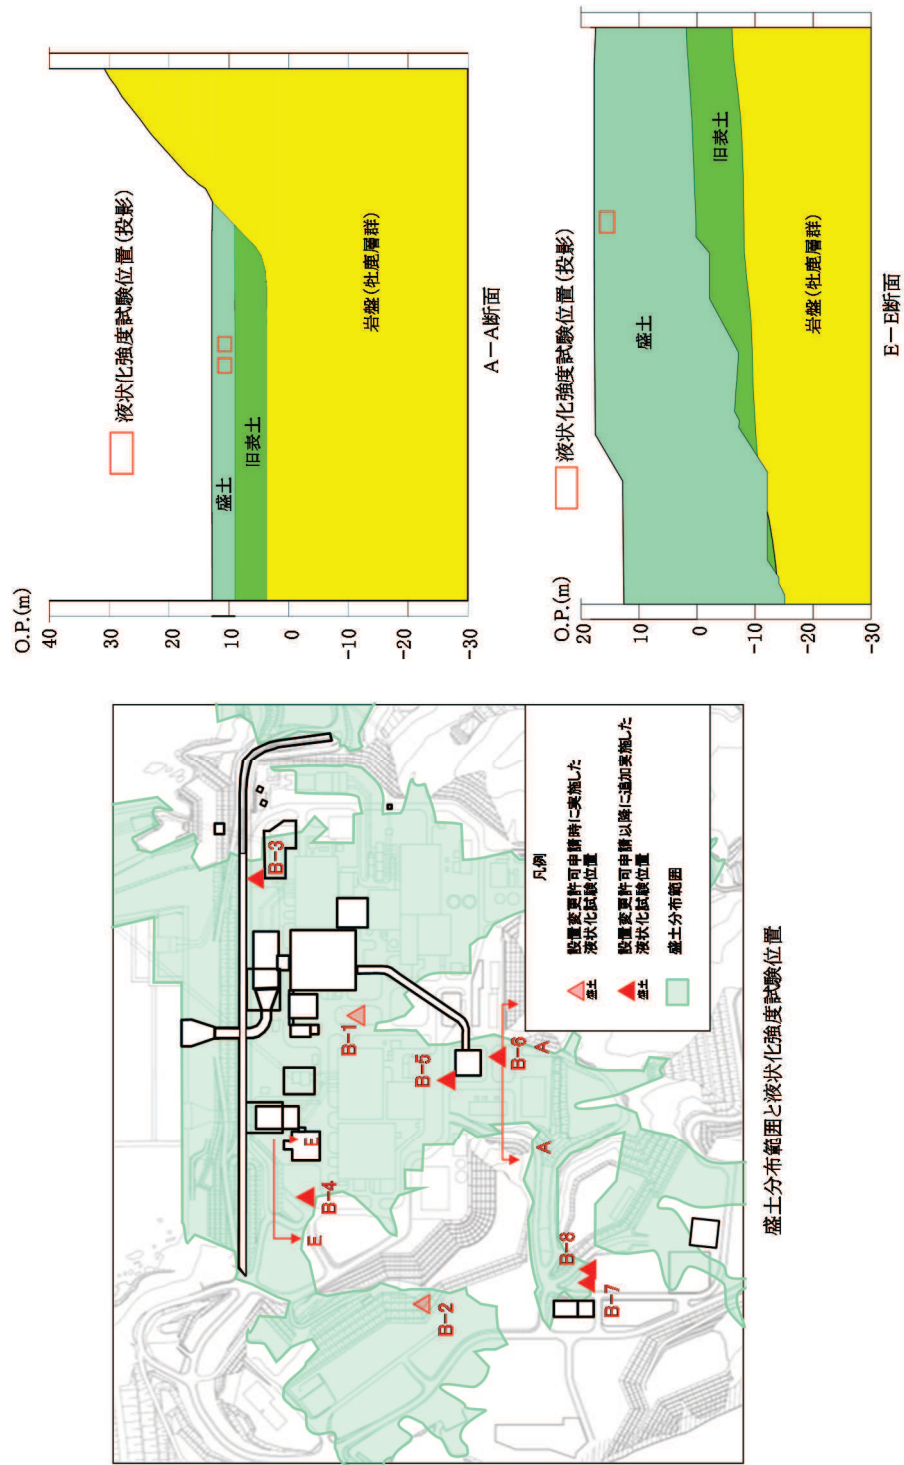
(2) 盛土の液状化強度試験に用いる試料採取位置断面図(2/3)
